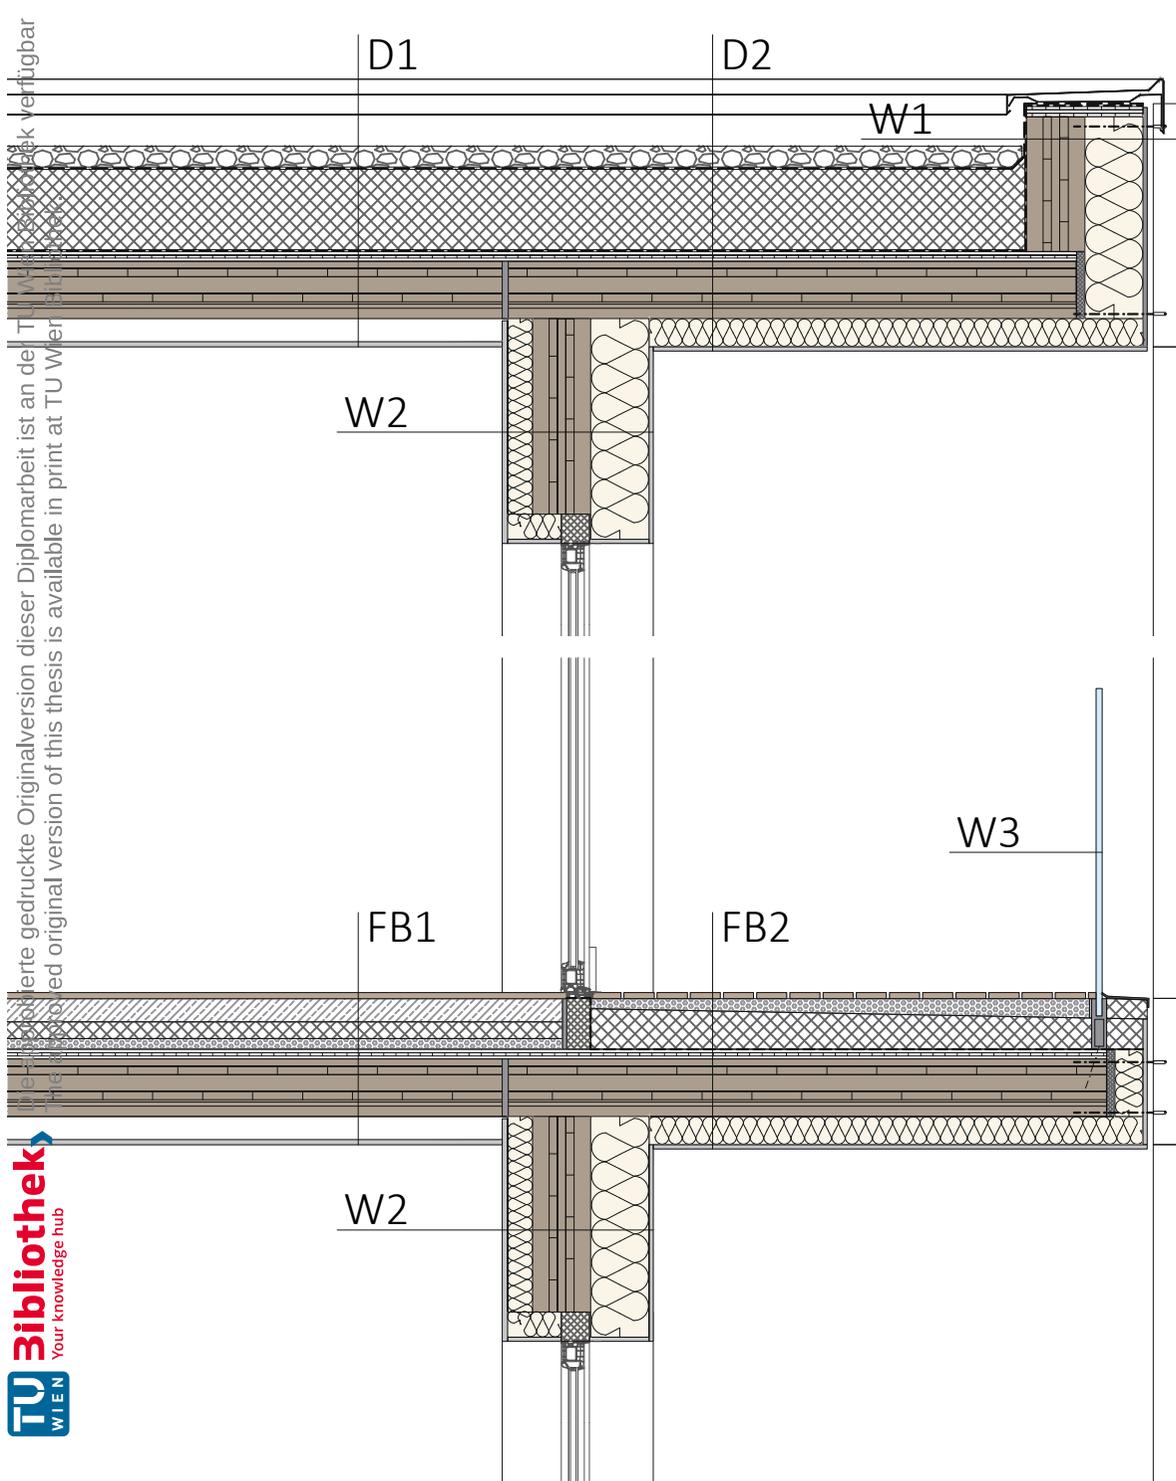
Dachdetail, Regelgeschoß Maßstab siehe Maßstabsleiste
